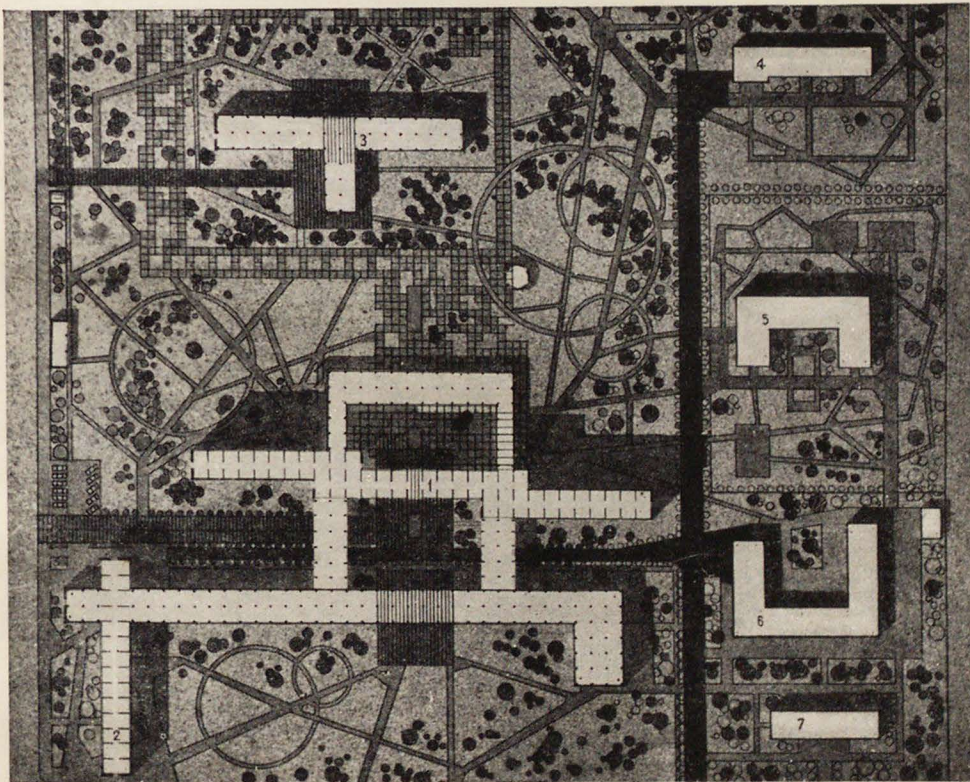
Больница на 1000 коек (ЦНИИЭП жилища). Генеральный план
